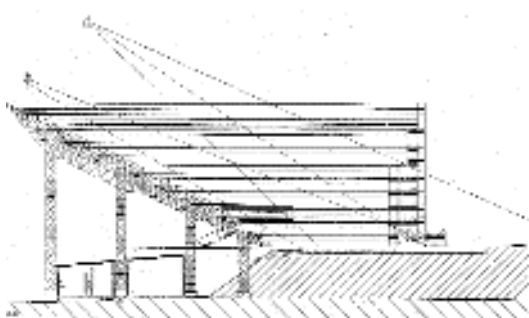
Plan et coupe du théâtre de plein air d'Athènes, 1965. (Roberto Aloï, op. cit.)
